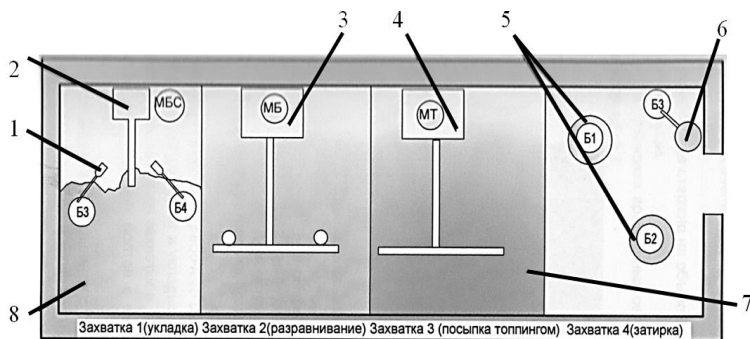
Схема организации рабочих мест при устройстве бетонных плит с применением фибробетона:
